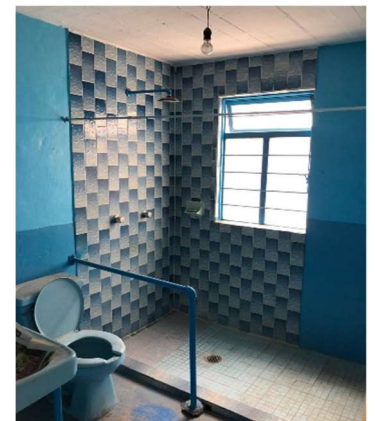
/ CASA LOS REYES – LA PAZ. / AUTOR: ARQ. JAVIER CASTELLANOS B. / SEPTIEMBRE - 2020
